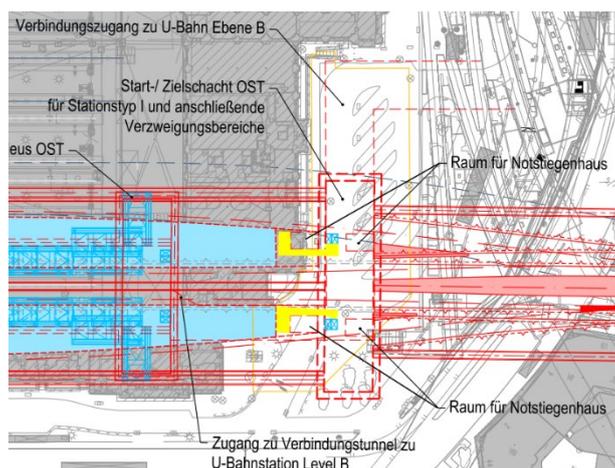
Lageplan Bergmännischer Stationstyp I, Nottreppenhäuser mit Stauraum (gelb dargestellt), Feuerwehraufzüge
